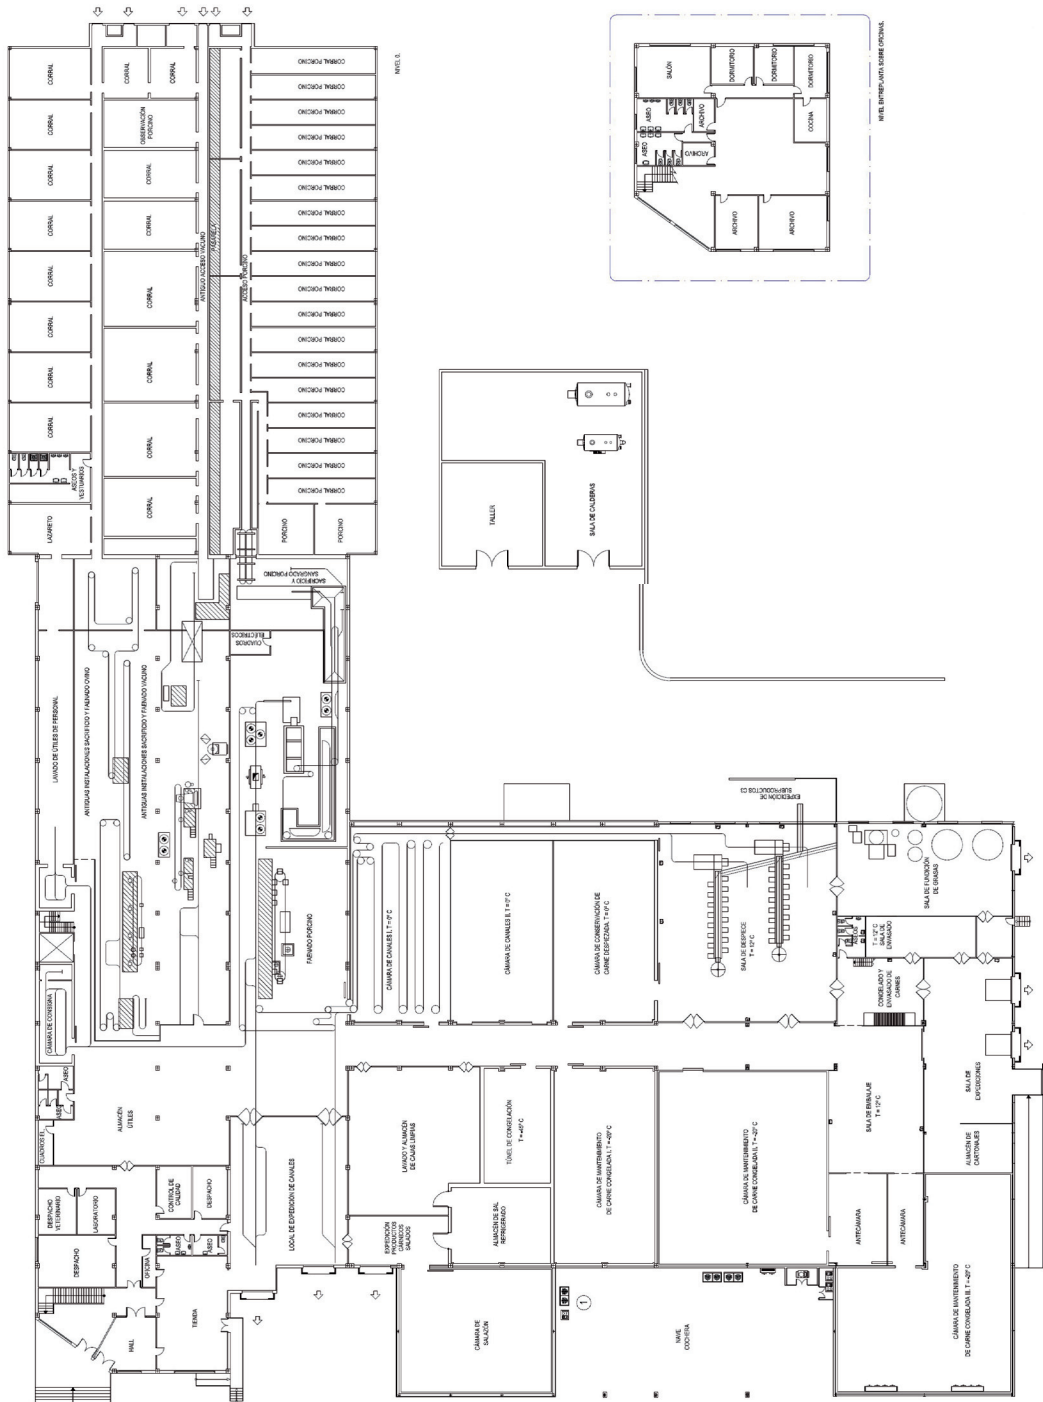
Plano en planta de la instalación (nivel 0 y sala de calderas)
